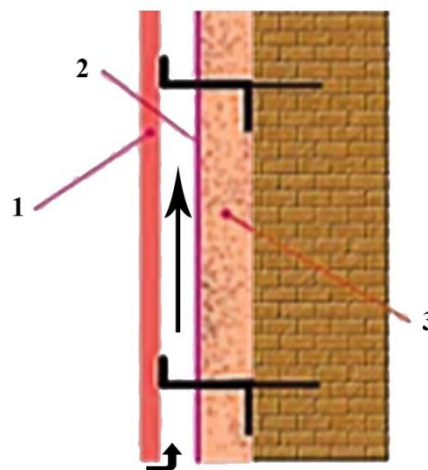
Конструкция утепленного вентилируемого фасада с ветрозащитной мембраной:
